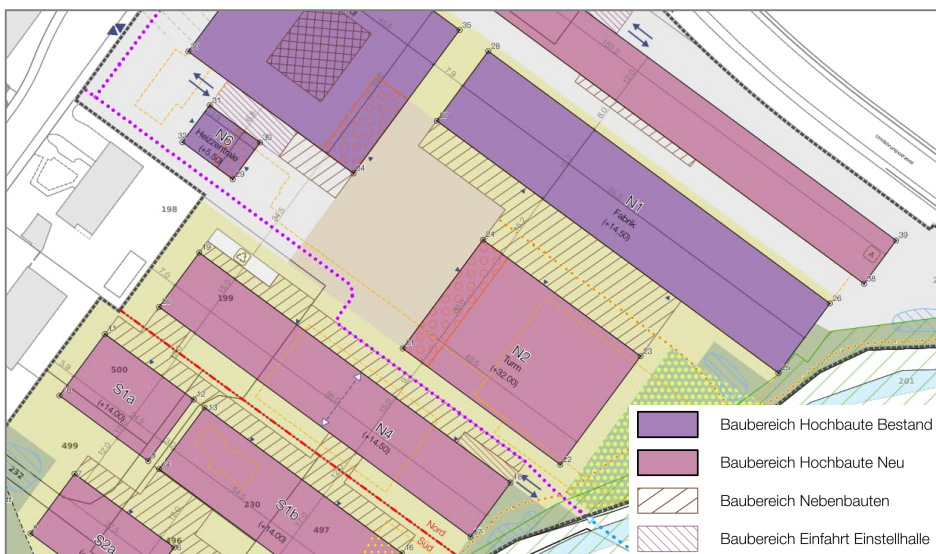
Ausschnitt Bebauungsplan mit Baubereichen
